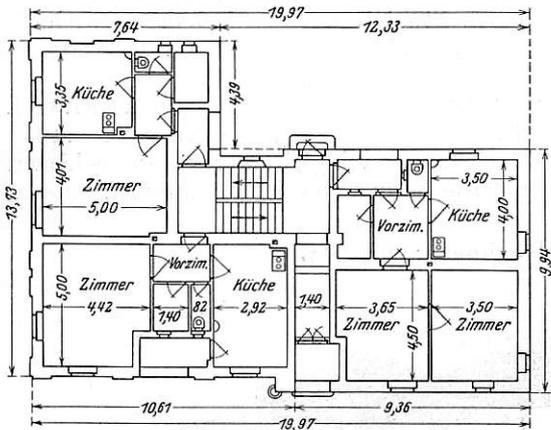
Grundriß des Erdgeschosses eines Arbeiterwohnhauses für sechs Familien.
